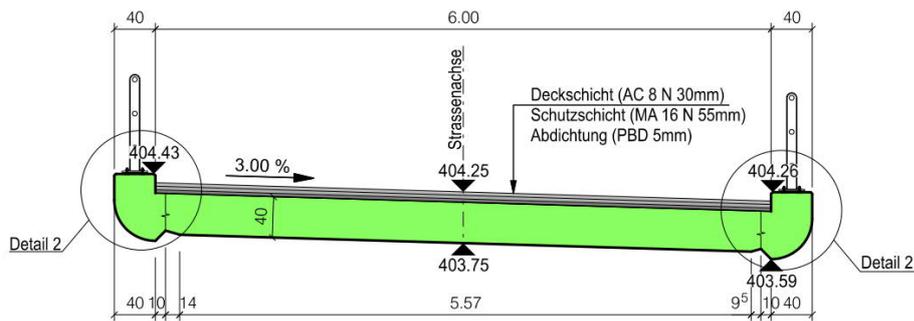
Querschnitt Brücke Kobelstrasse, Littenbach
